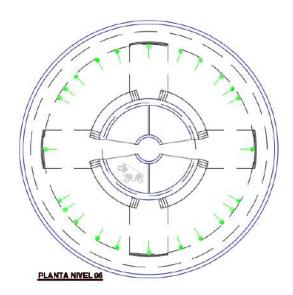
Planta del sexto nivel. (Fuente Autor)
